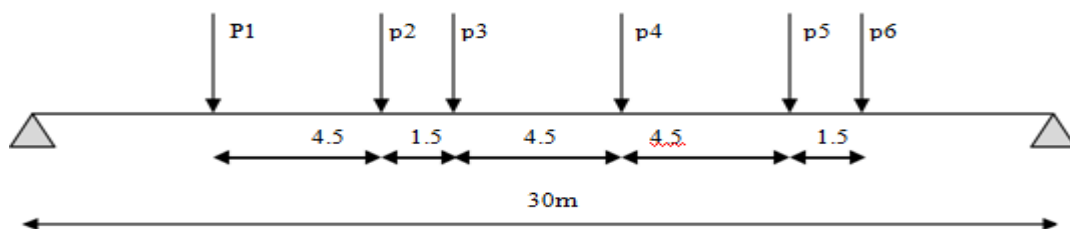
Système disposition de deux camions sur la chaussée (sens longitudinal)
